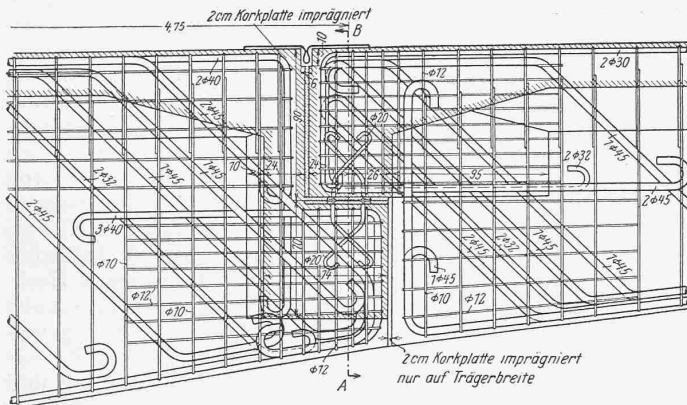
Bewegliches Gerbergelenk; Masstab 1 : 40. Detail des Platten-Gleitlagers siehe Abb. 5.
